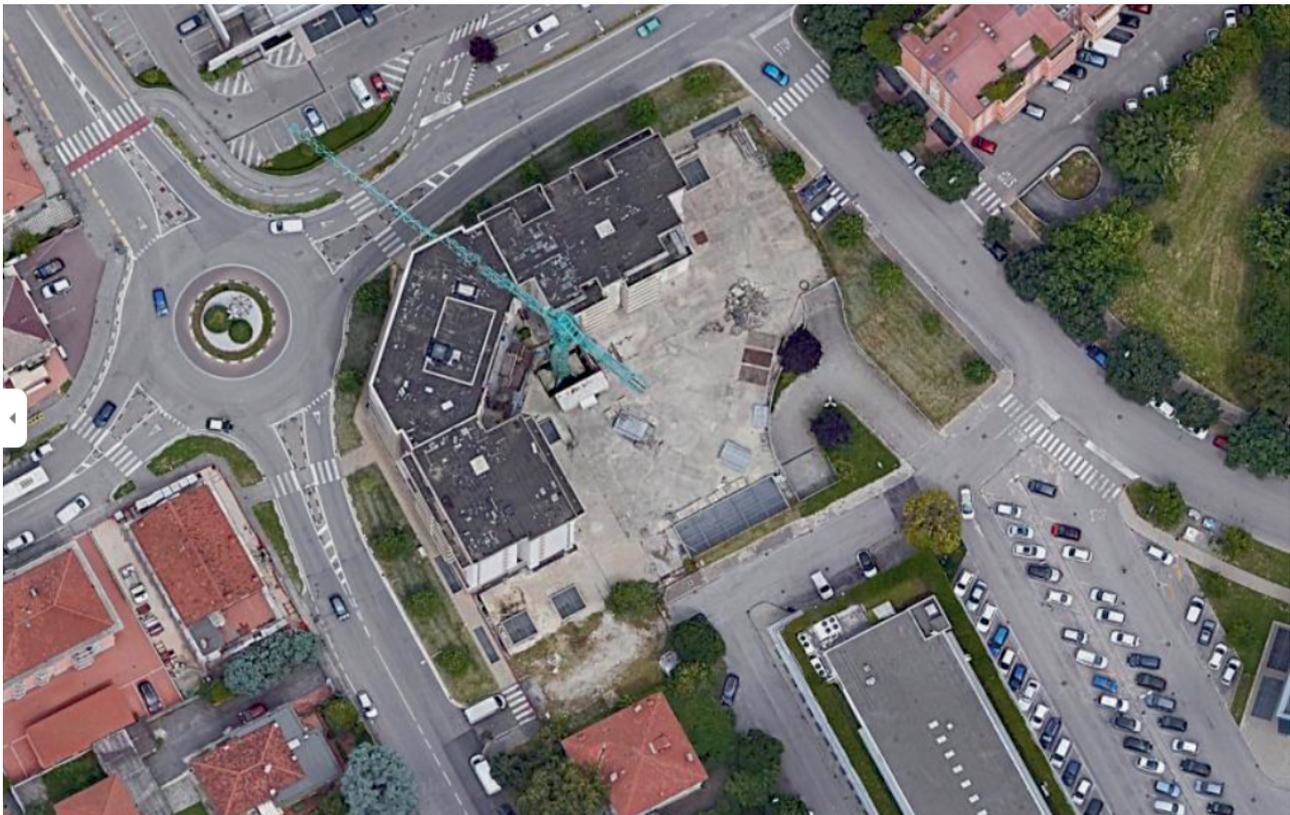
FOTO AEREA DEL CANTIERE DI RISTRUTTURAZIONE
